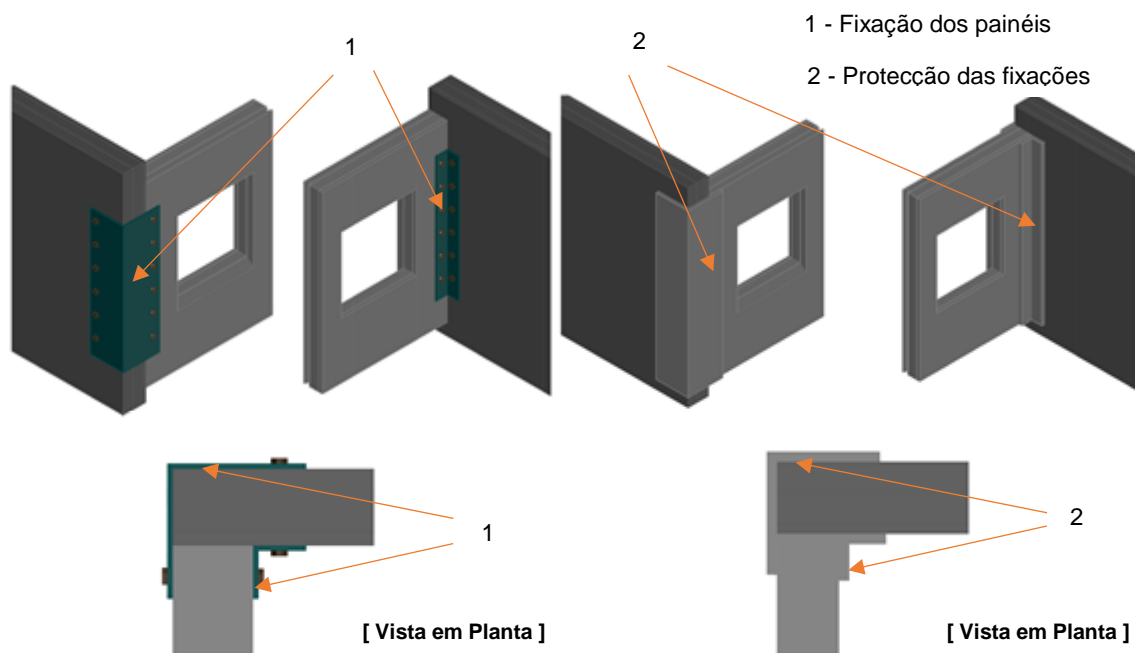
Esquema do sistema de fixação de painéis perde canto
